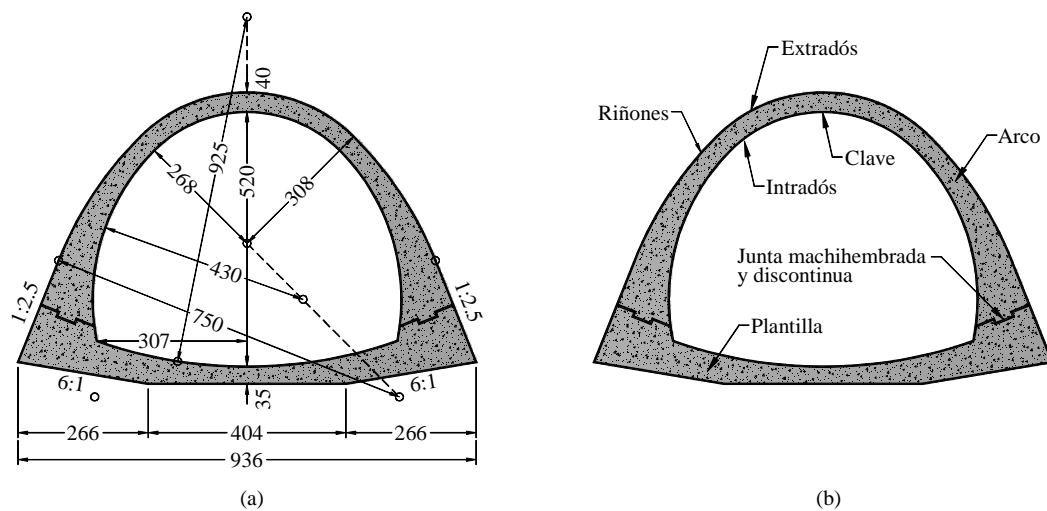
Sección transversal del túnel estudiado: (a) dimensiones generales en centímetros; (b) componentes
